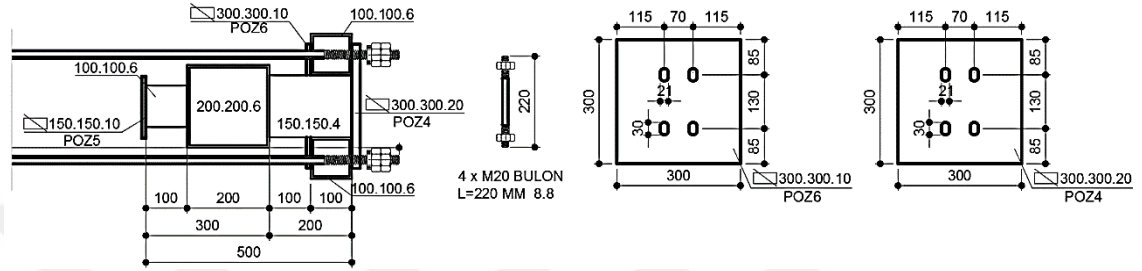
Aksel Yükleme Düzenği Kolon Aplikasyon Planı [51, 58]
